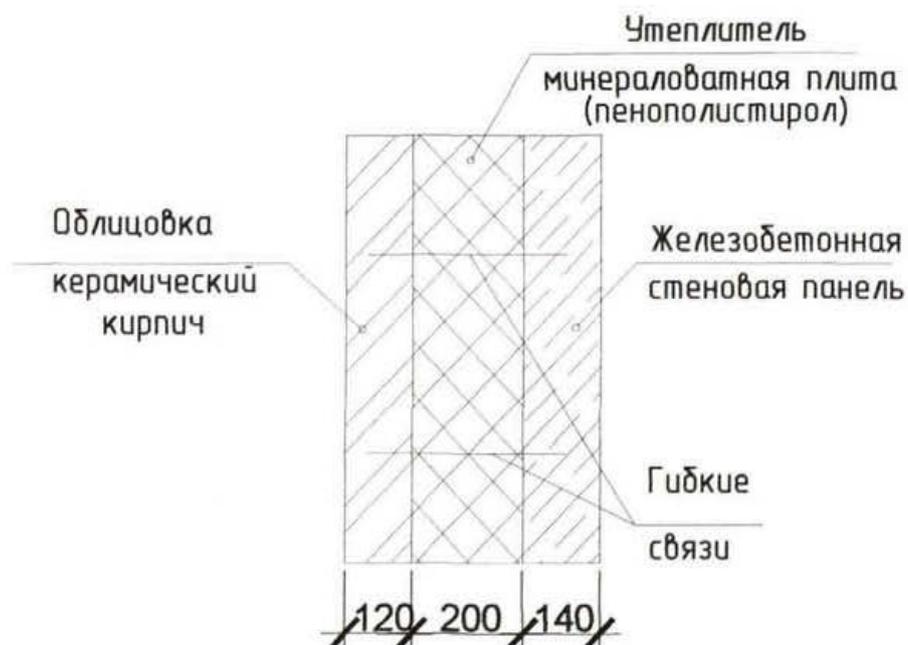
Структура теплоэффективной наружной стены в составе панельной стены
